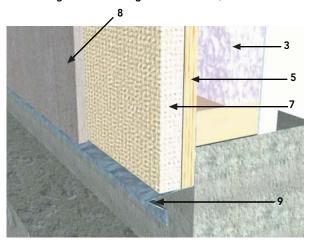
95: Vista exterior de la zona baja del tabique perimetral con los diferentes componentes.
